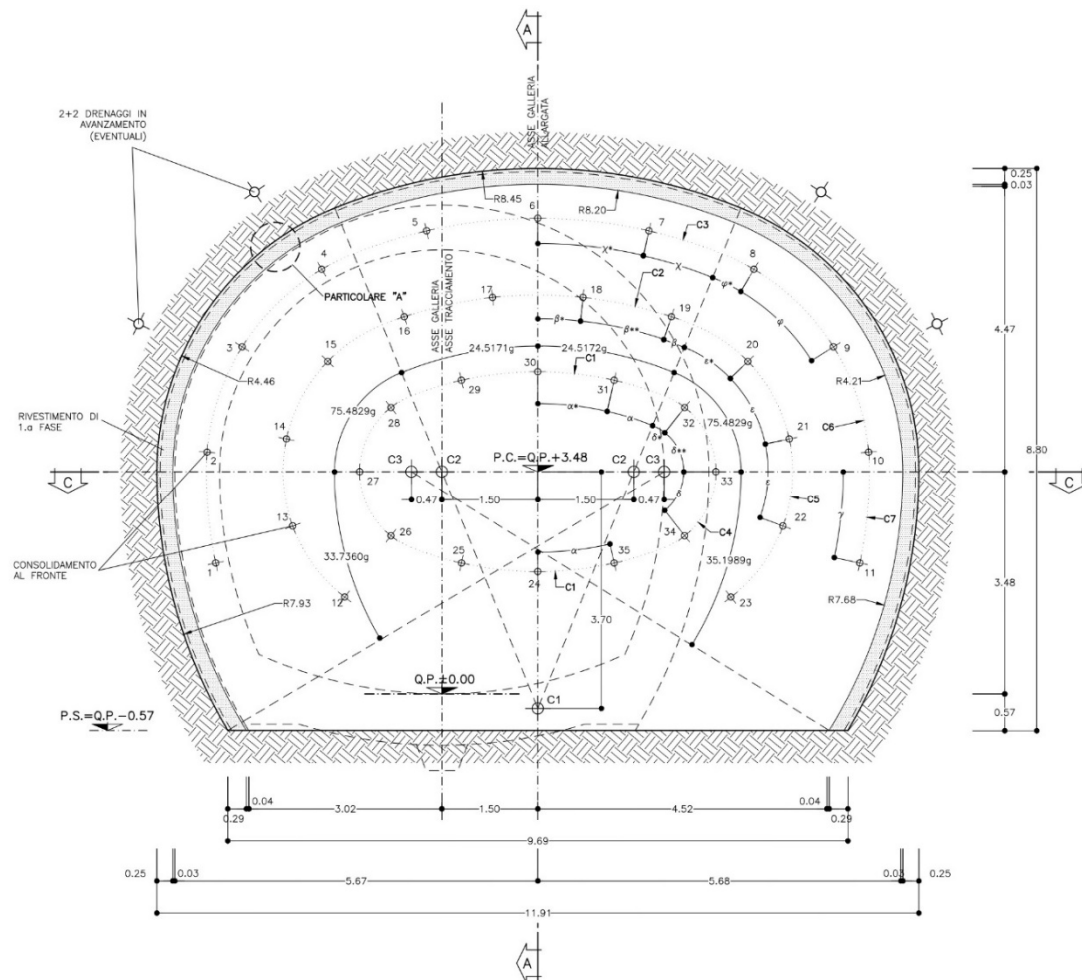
Sezione Tipo B2 “Allargata” – Scavi e consolidamenti - Sezione
